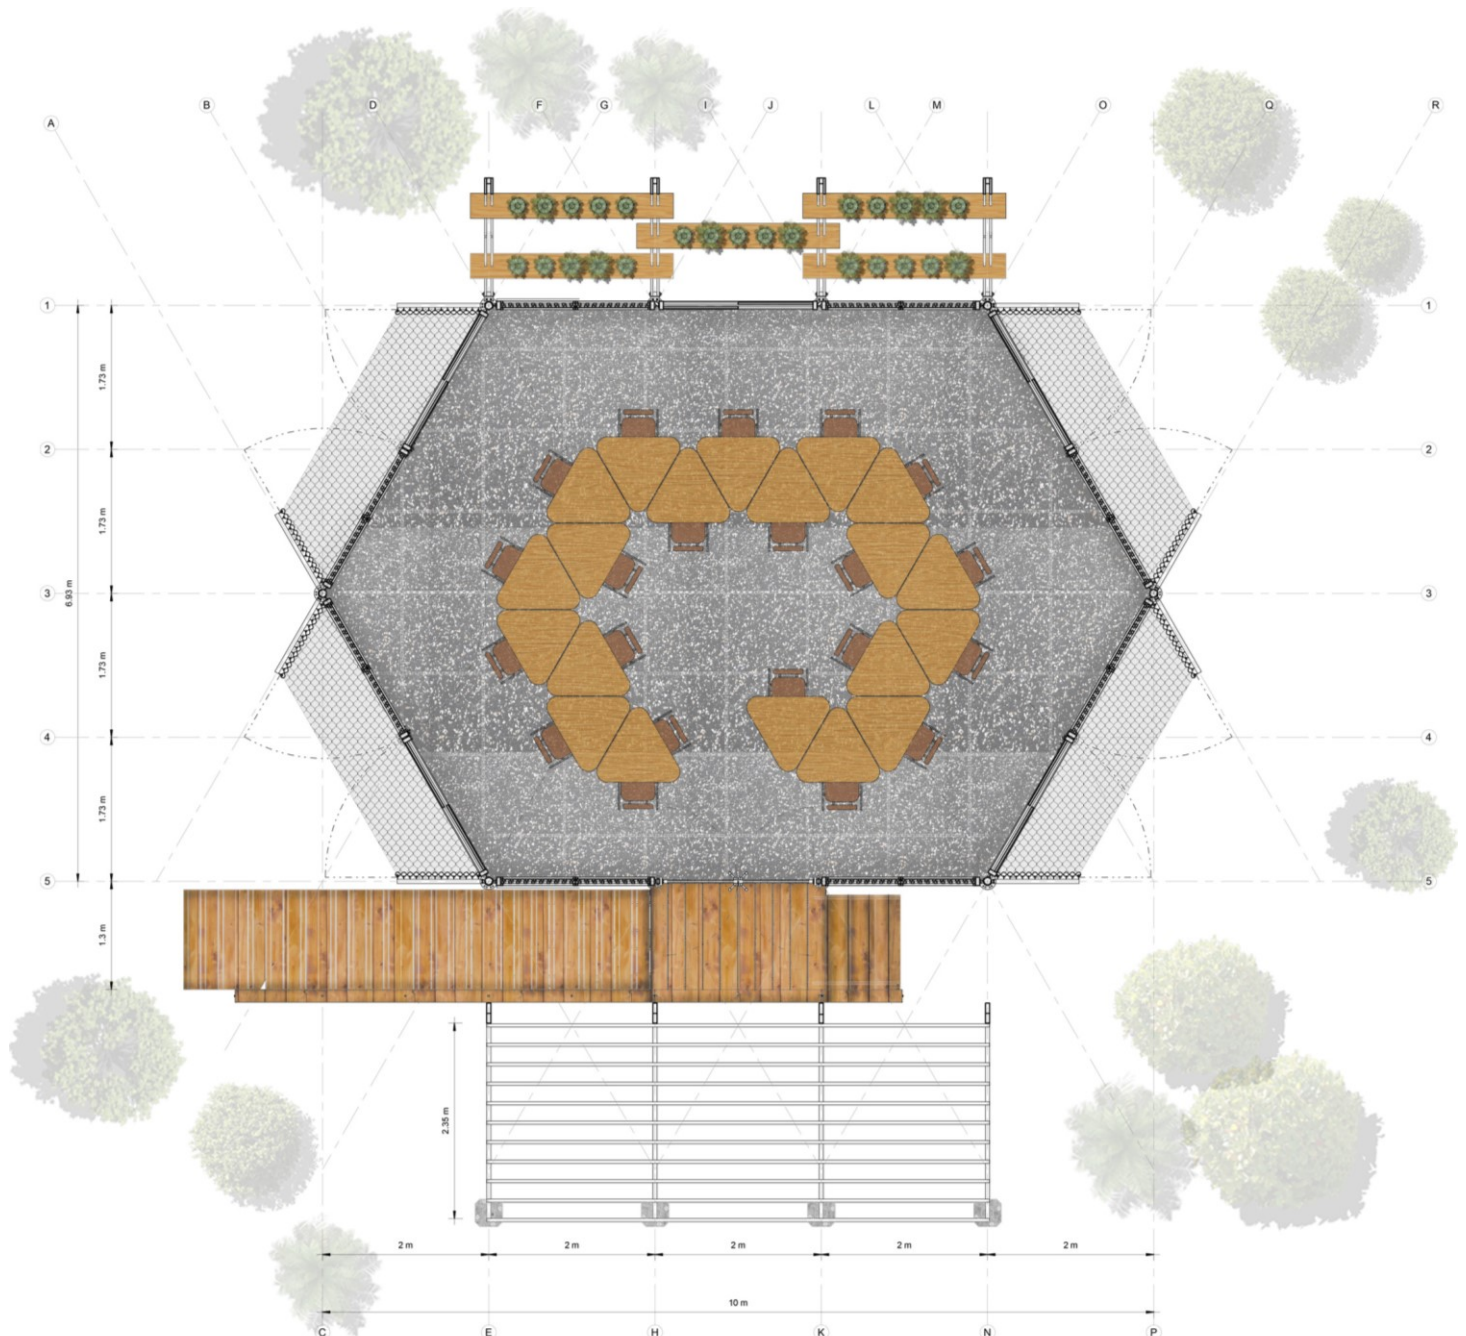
Planta de distribución arquitectónica del módulo tipología B.<sup>229</sup>
